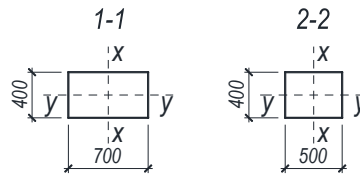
Поперечное сечение элементов плоской рамы (каркаса)
